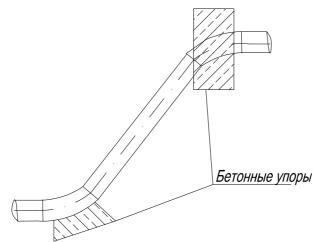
Типовая схема обустройства вертикального угла поворота опорными блоками.
